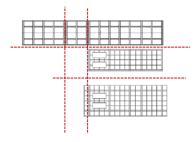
(i) Denah Pembalokan Lantai 7
